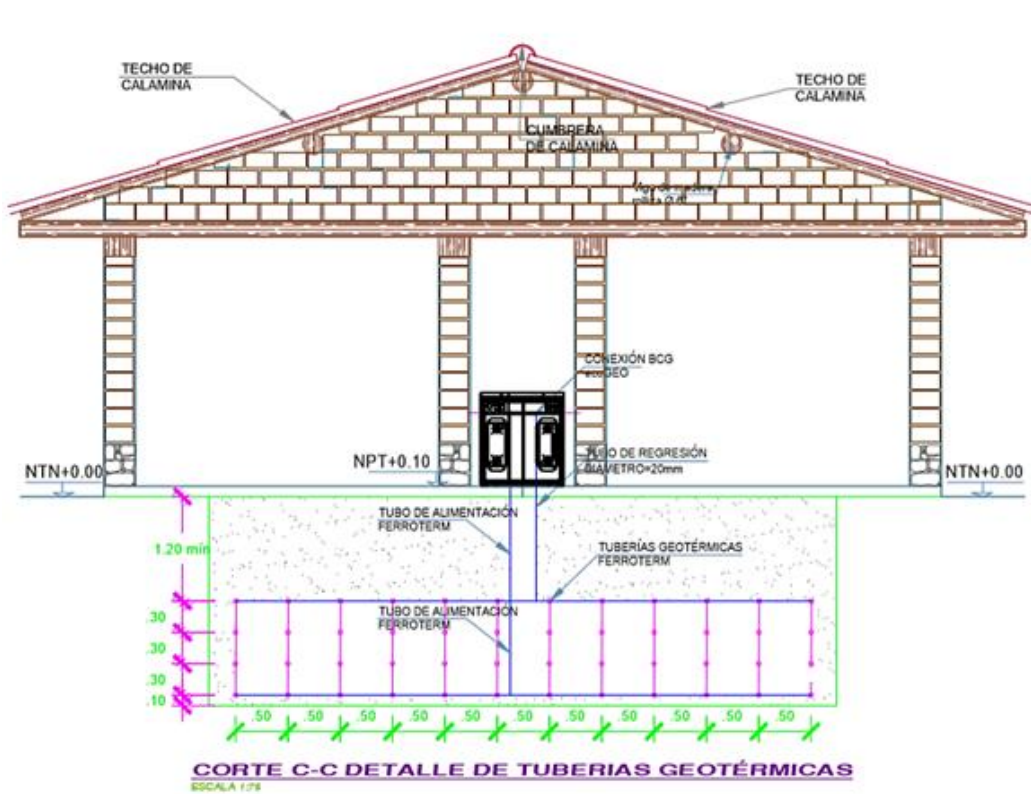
Plano con detalles de instalación de tuberías geotérmicas, Esc. 1/75
